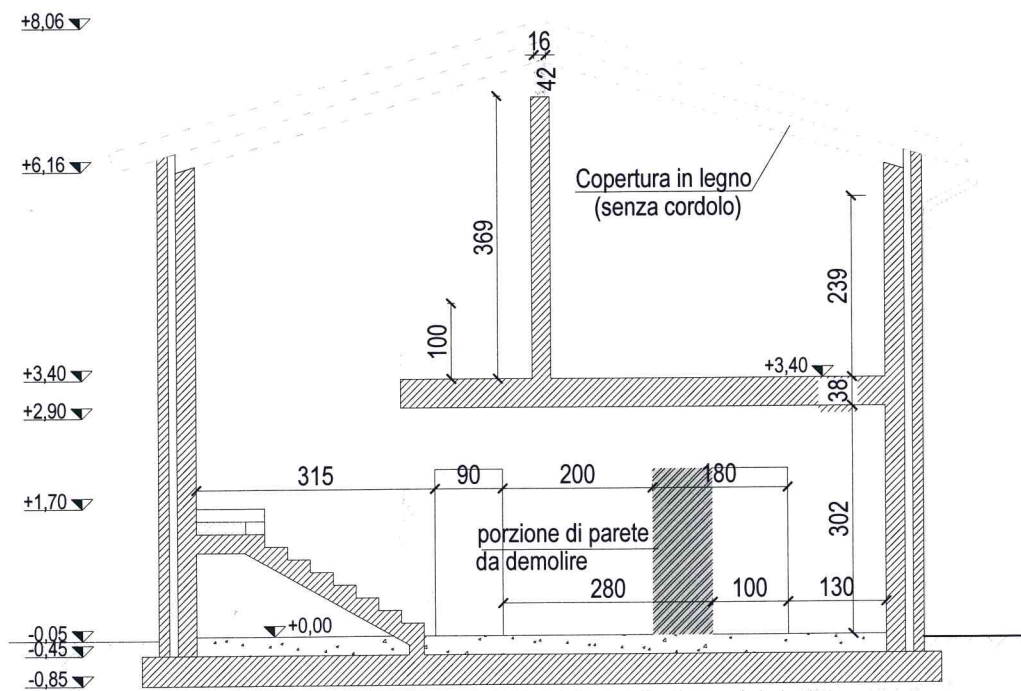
sezione della struttura in corrispondenza dell'allineamento murario oggetto dell'intervento 1
